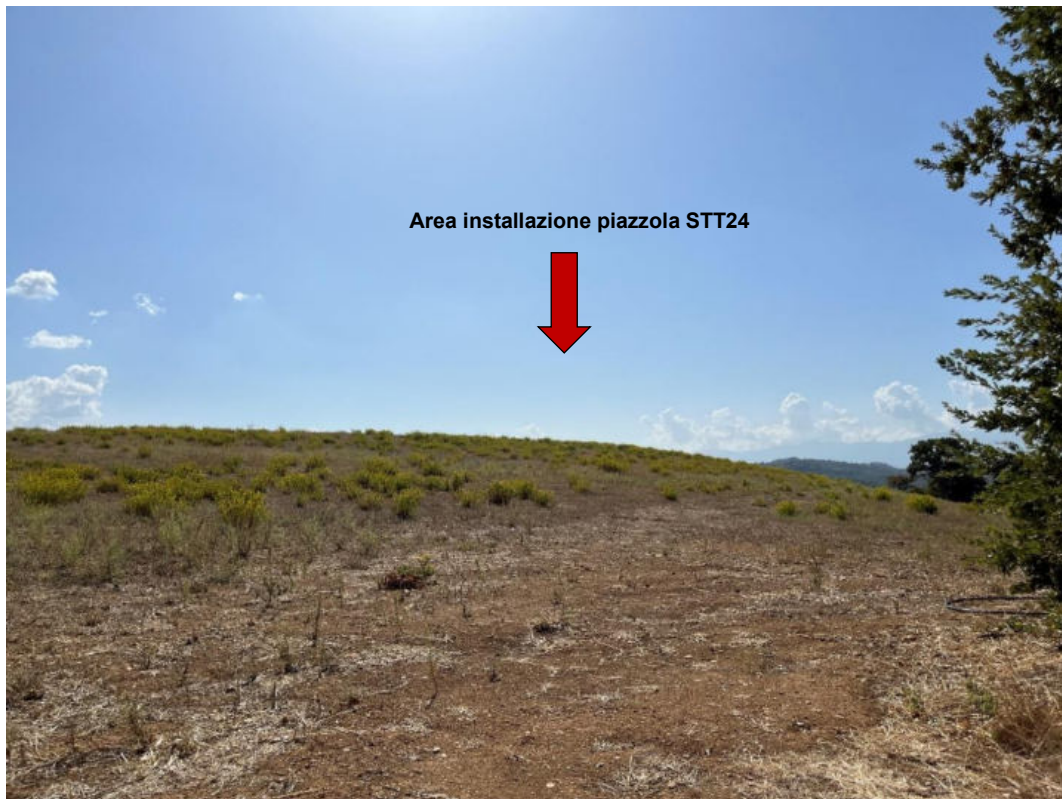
PV27 – Area di installazione della piazzola e STT24.
